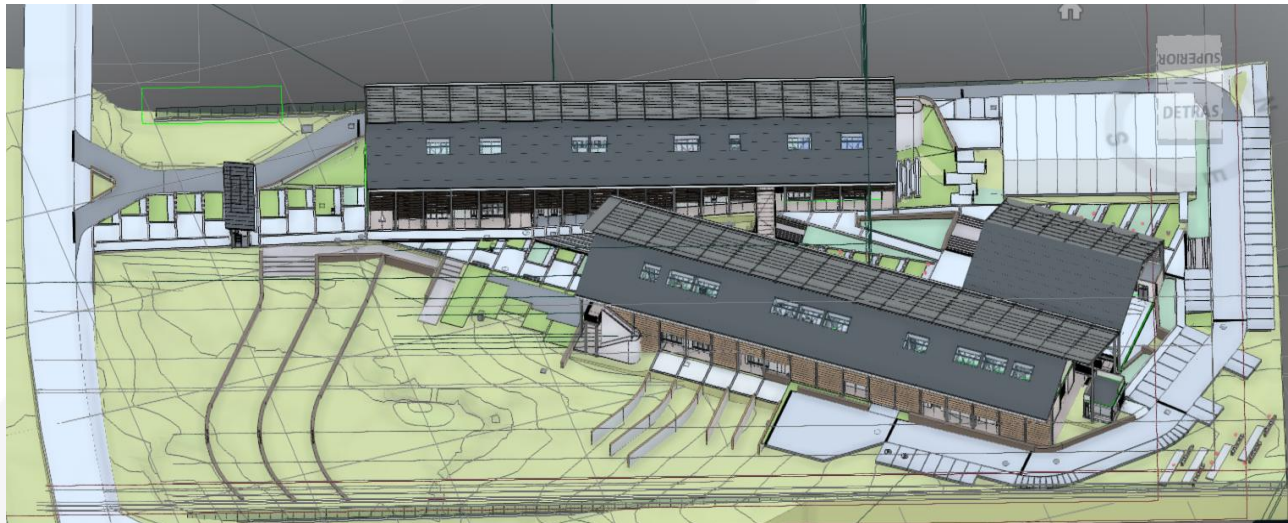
Perspectiva o render principal del conjunto, extraído de la Plancha 1, que muestre la volumetría general y el eje central.
